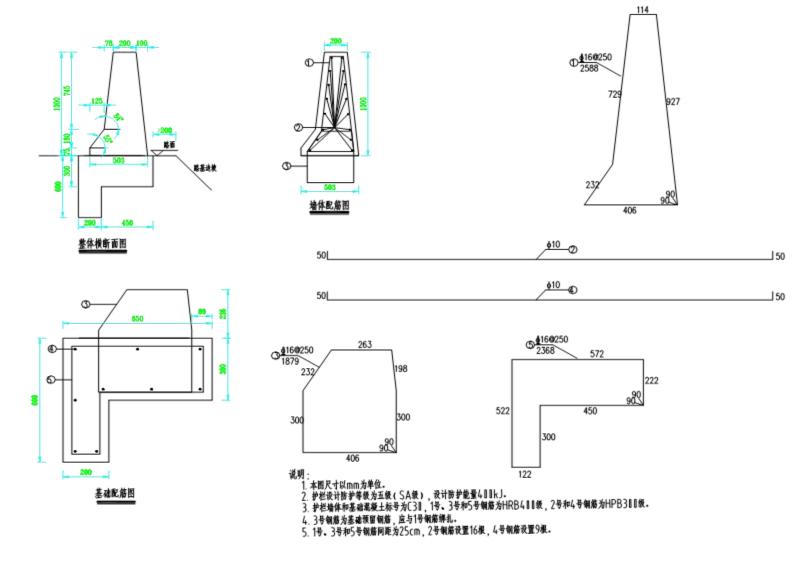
五 (SA) 级 F 型路基混凝土护栏设计示例 (尺寸单位: mm)
